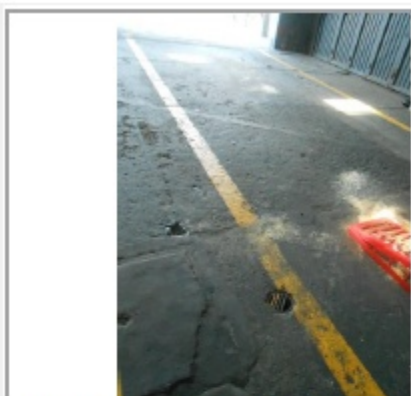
Conexiones con la red de alcantarillado en la zona de lubricación
